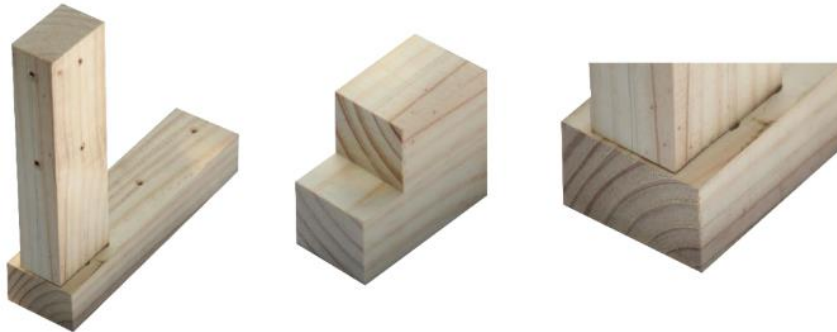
Ensamble caja y espiga unilateral | Detalle espiga 2 | Detalle ensamblaje.
